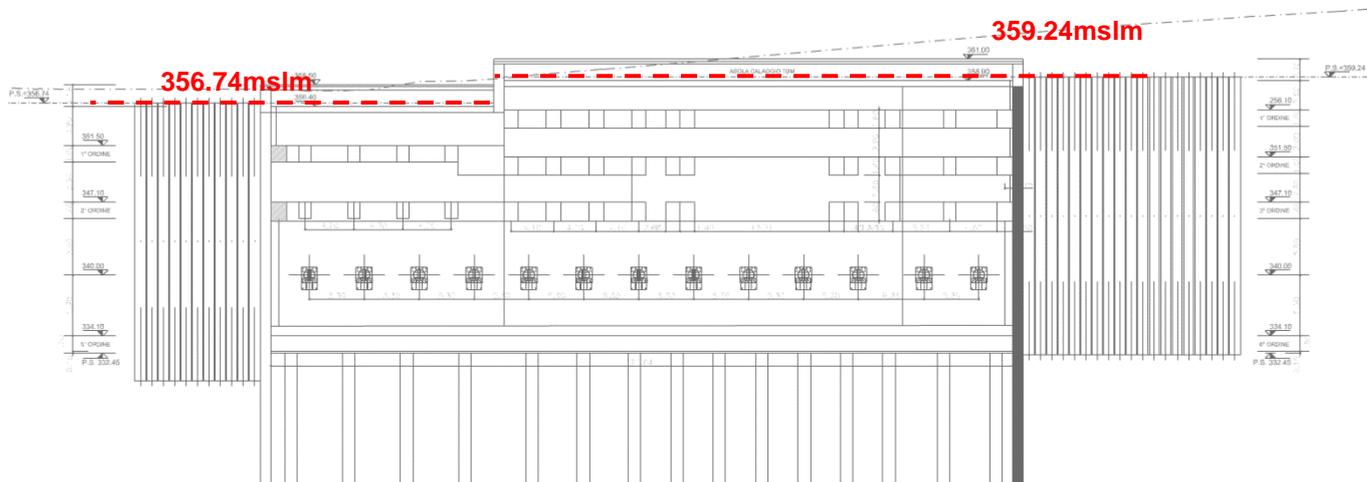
Sezione longitudinale pozzo : Piani di lavoro
